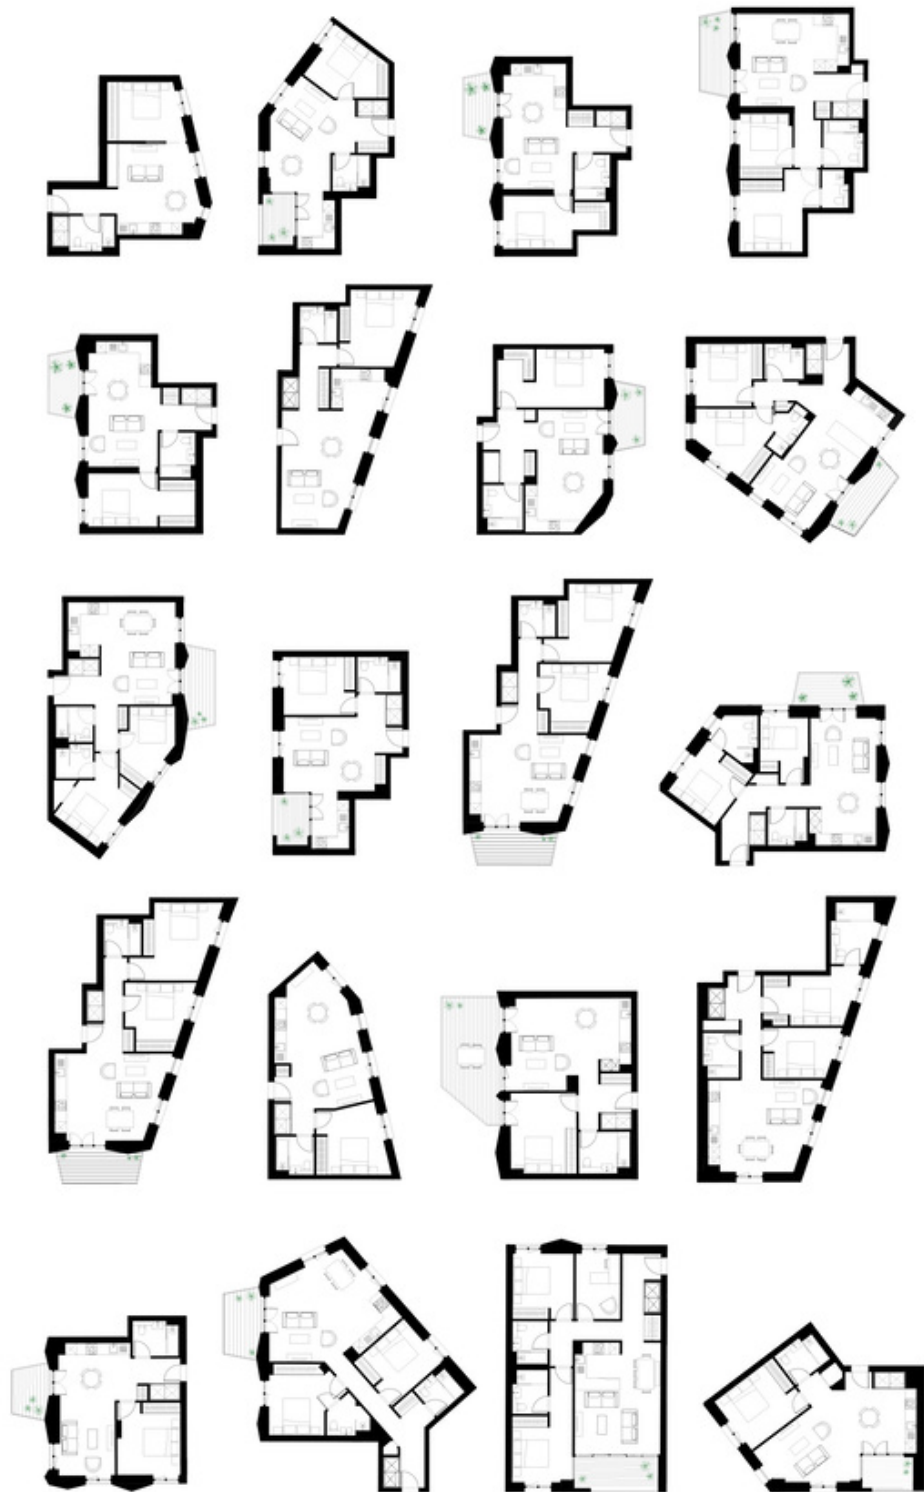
Плавання квартир в One Ashley Road Building [28]
